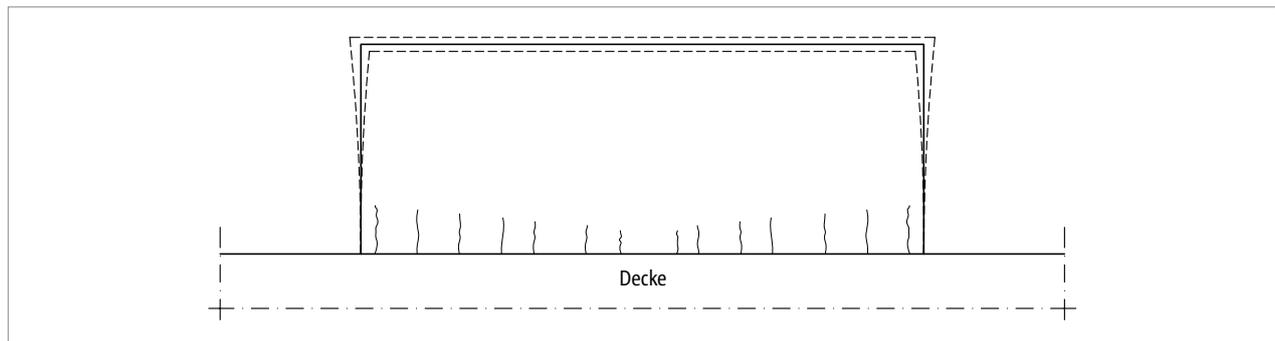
Balkonplatte ohne Schöck Isokorb®: Rissbildung durch Ermüdung möglich
